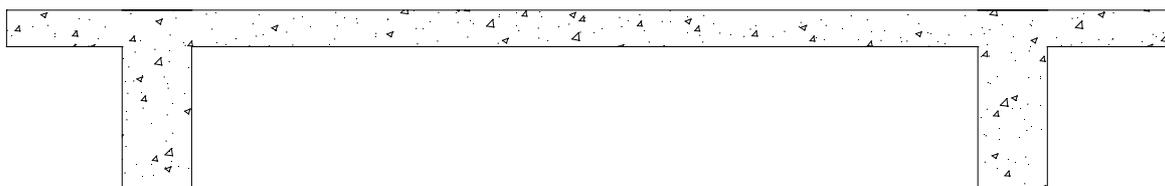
Piso de um edifício comum – Laje apoiando-se nas vigas
